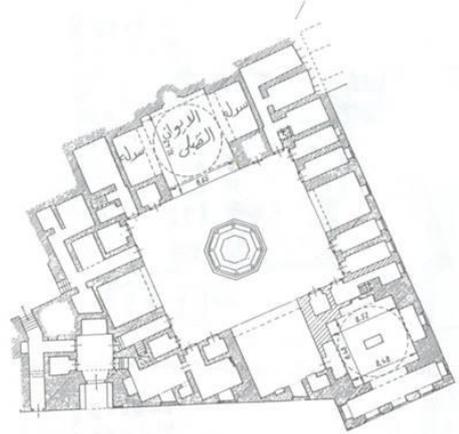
مسقط أفقي لمدرسة السلطان حسن، مُتَّلا عن هورتو.
